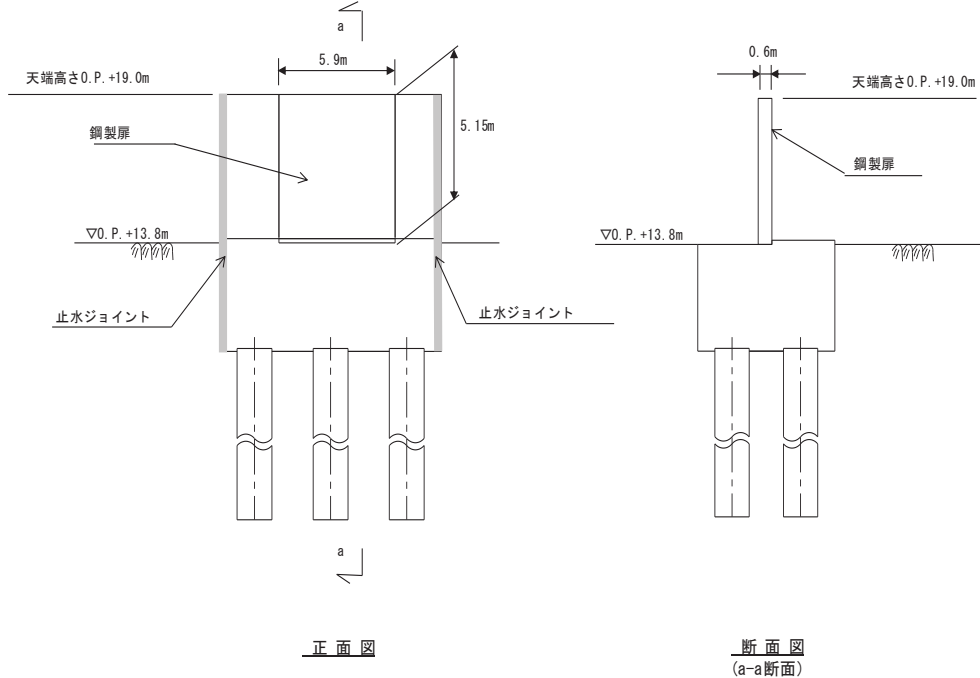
鋼製扉 2 正面図及び断面図
